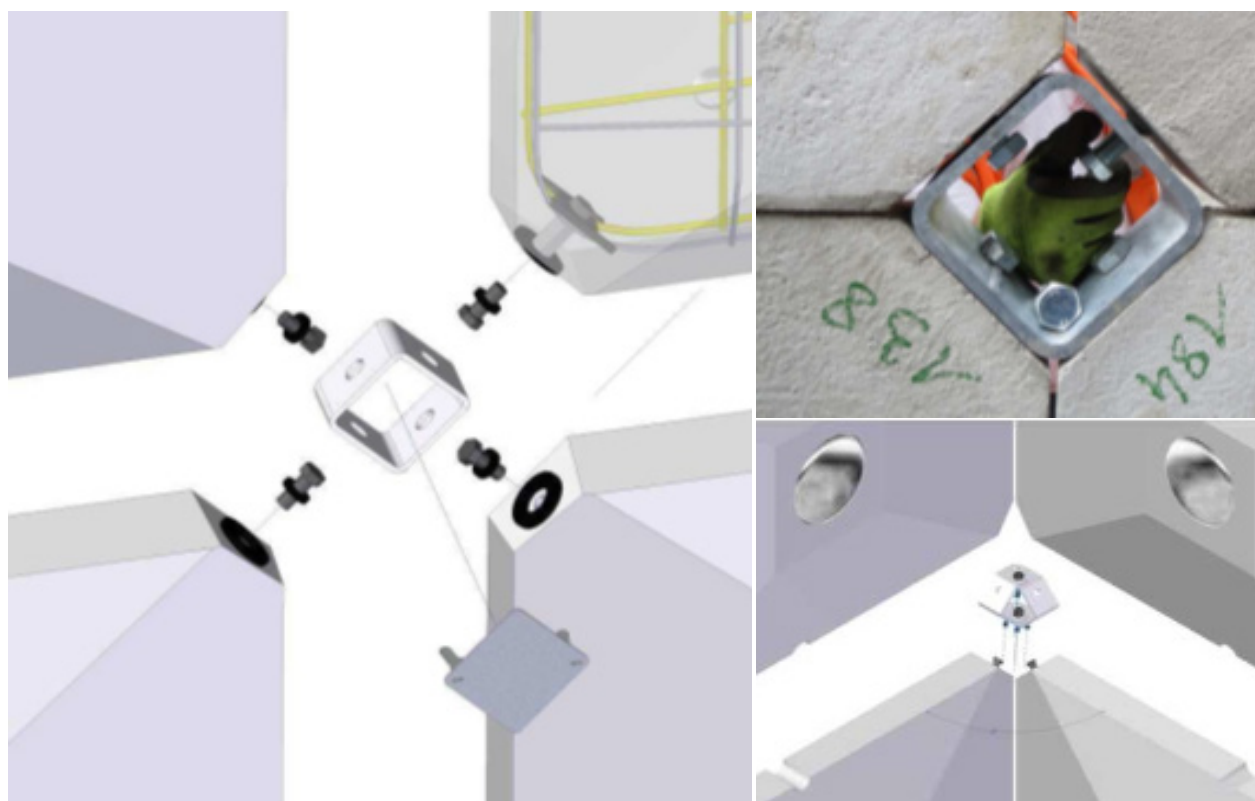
Detalle de accesorios para conexión entre paneles de concreto (ilustrativo)
